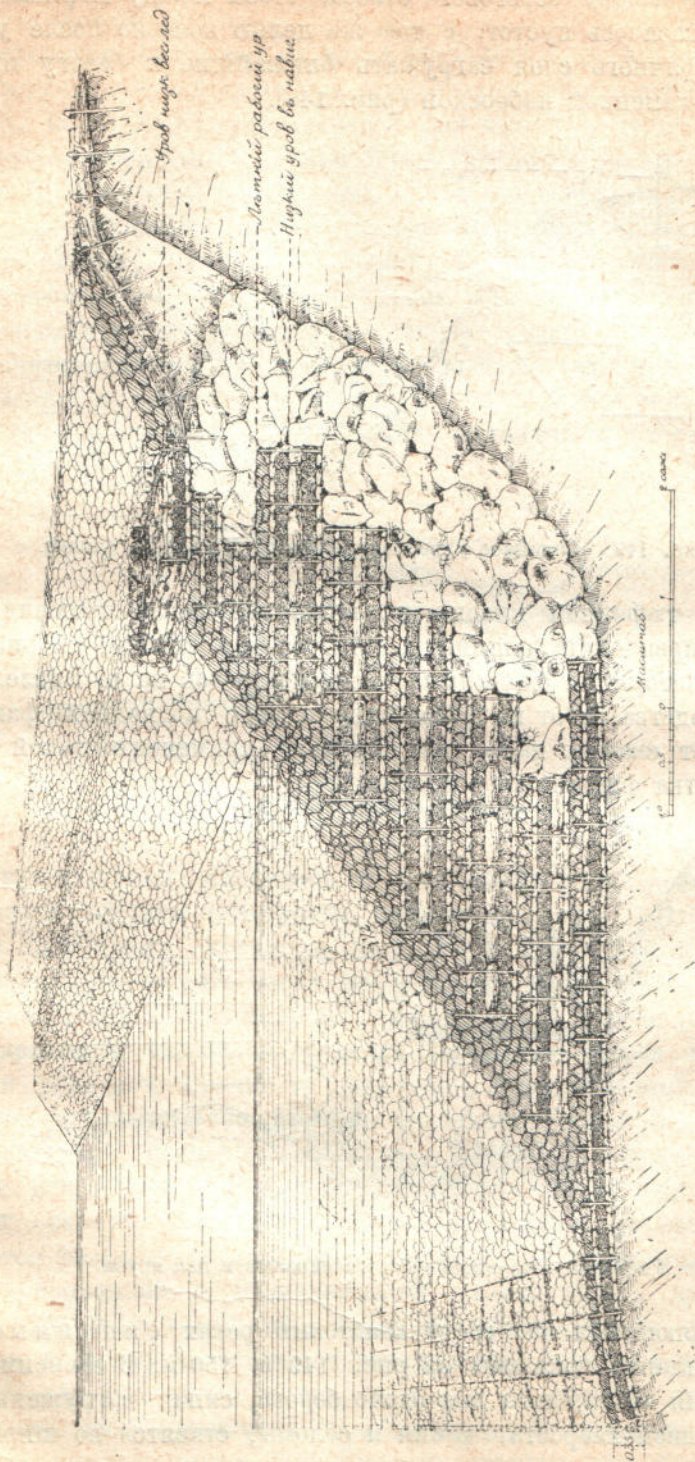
Укрепление берега, в виде опояски, из кладки фашинных тыфяков на р. Волге.
